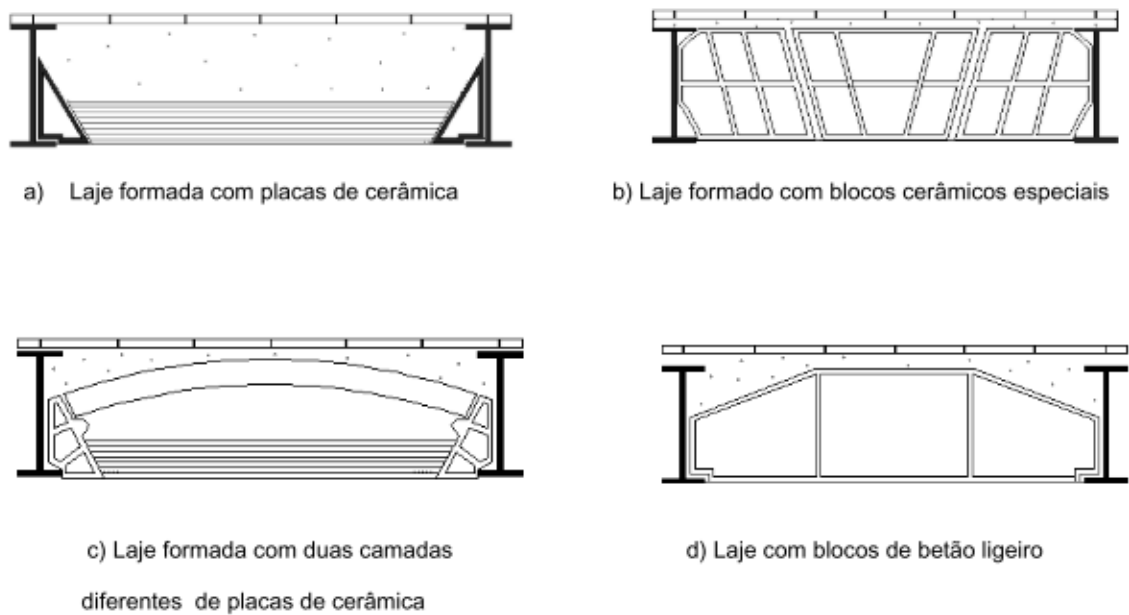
Lajes com perfis de ferro e blocos de aligeiramento [5]
